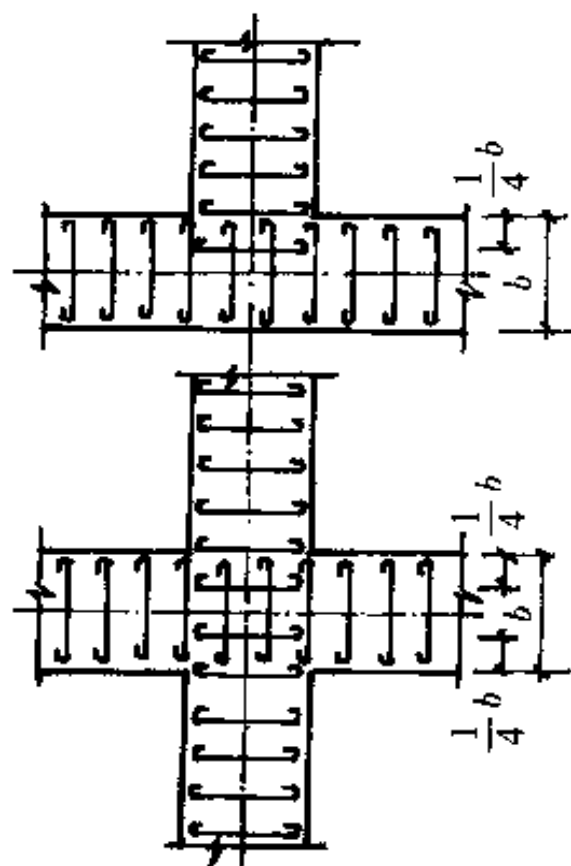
扩展基础底板 T 形及十字形交接处受力钢筋布置示意图
